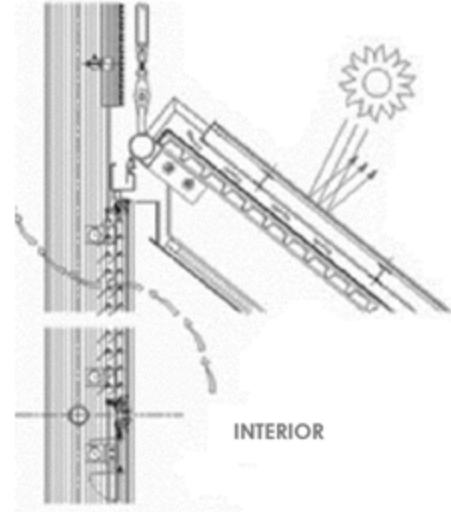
Unión del sistema de cubierta de la cabaña con el sistema de fachada. RPBW (s.f.).
